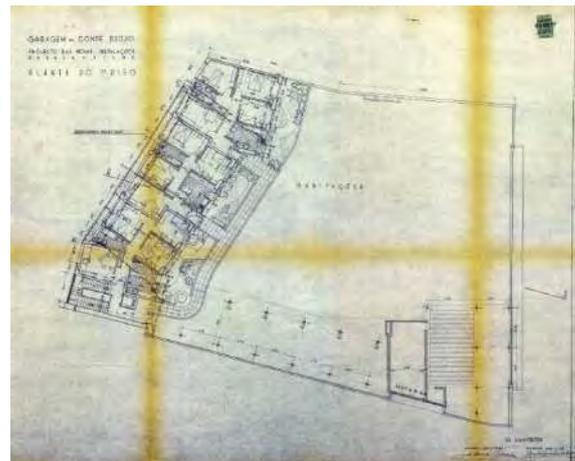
"Garagem do Conde Barão - Projecto das novas instalações - Planta do 7º Piso" (Fonte: Obra 331-Volume 1-Processo 10818/DAG/PG/1952 - Tomo 1; Página 23)
